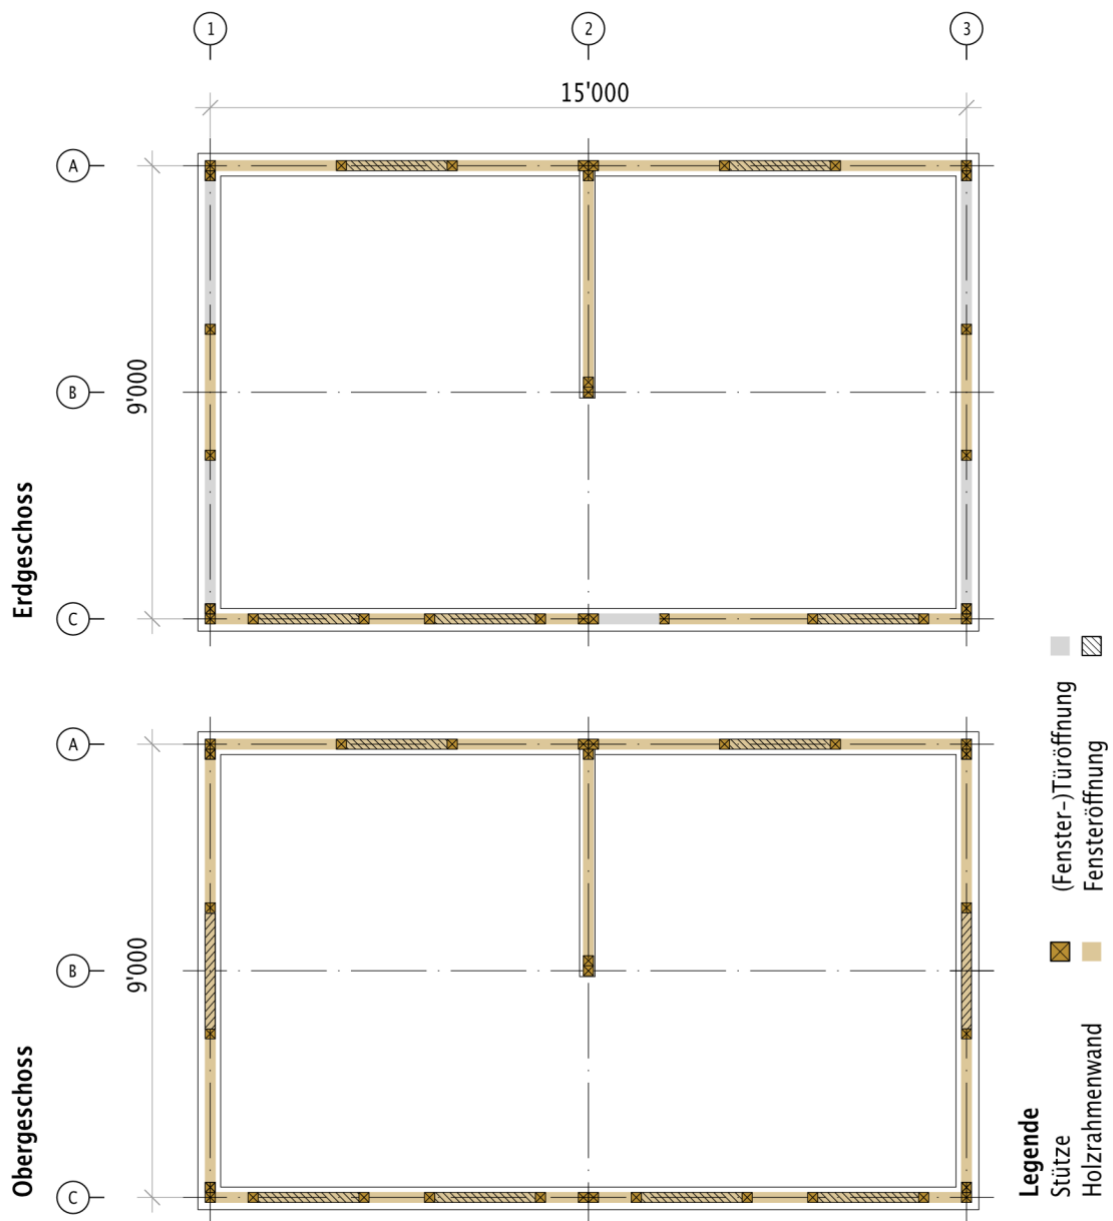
Schematischer Grundriss von Erd- und Obergeschoss des zweistöckigen Mustergebäudes.
